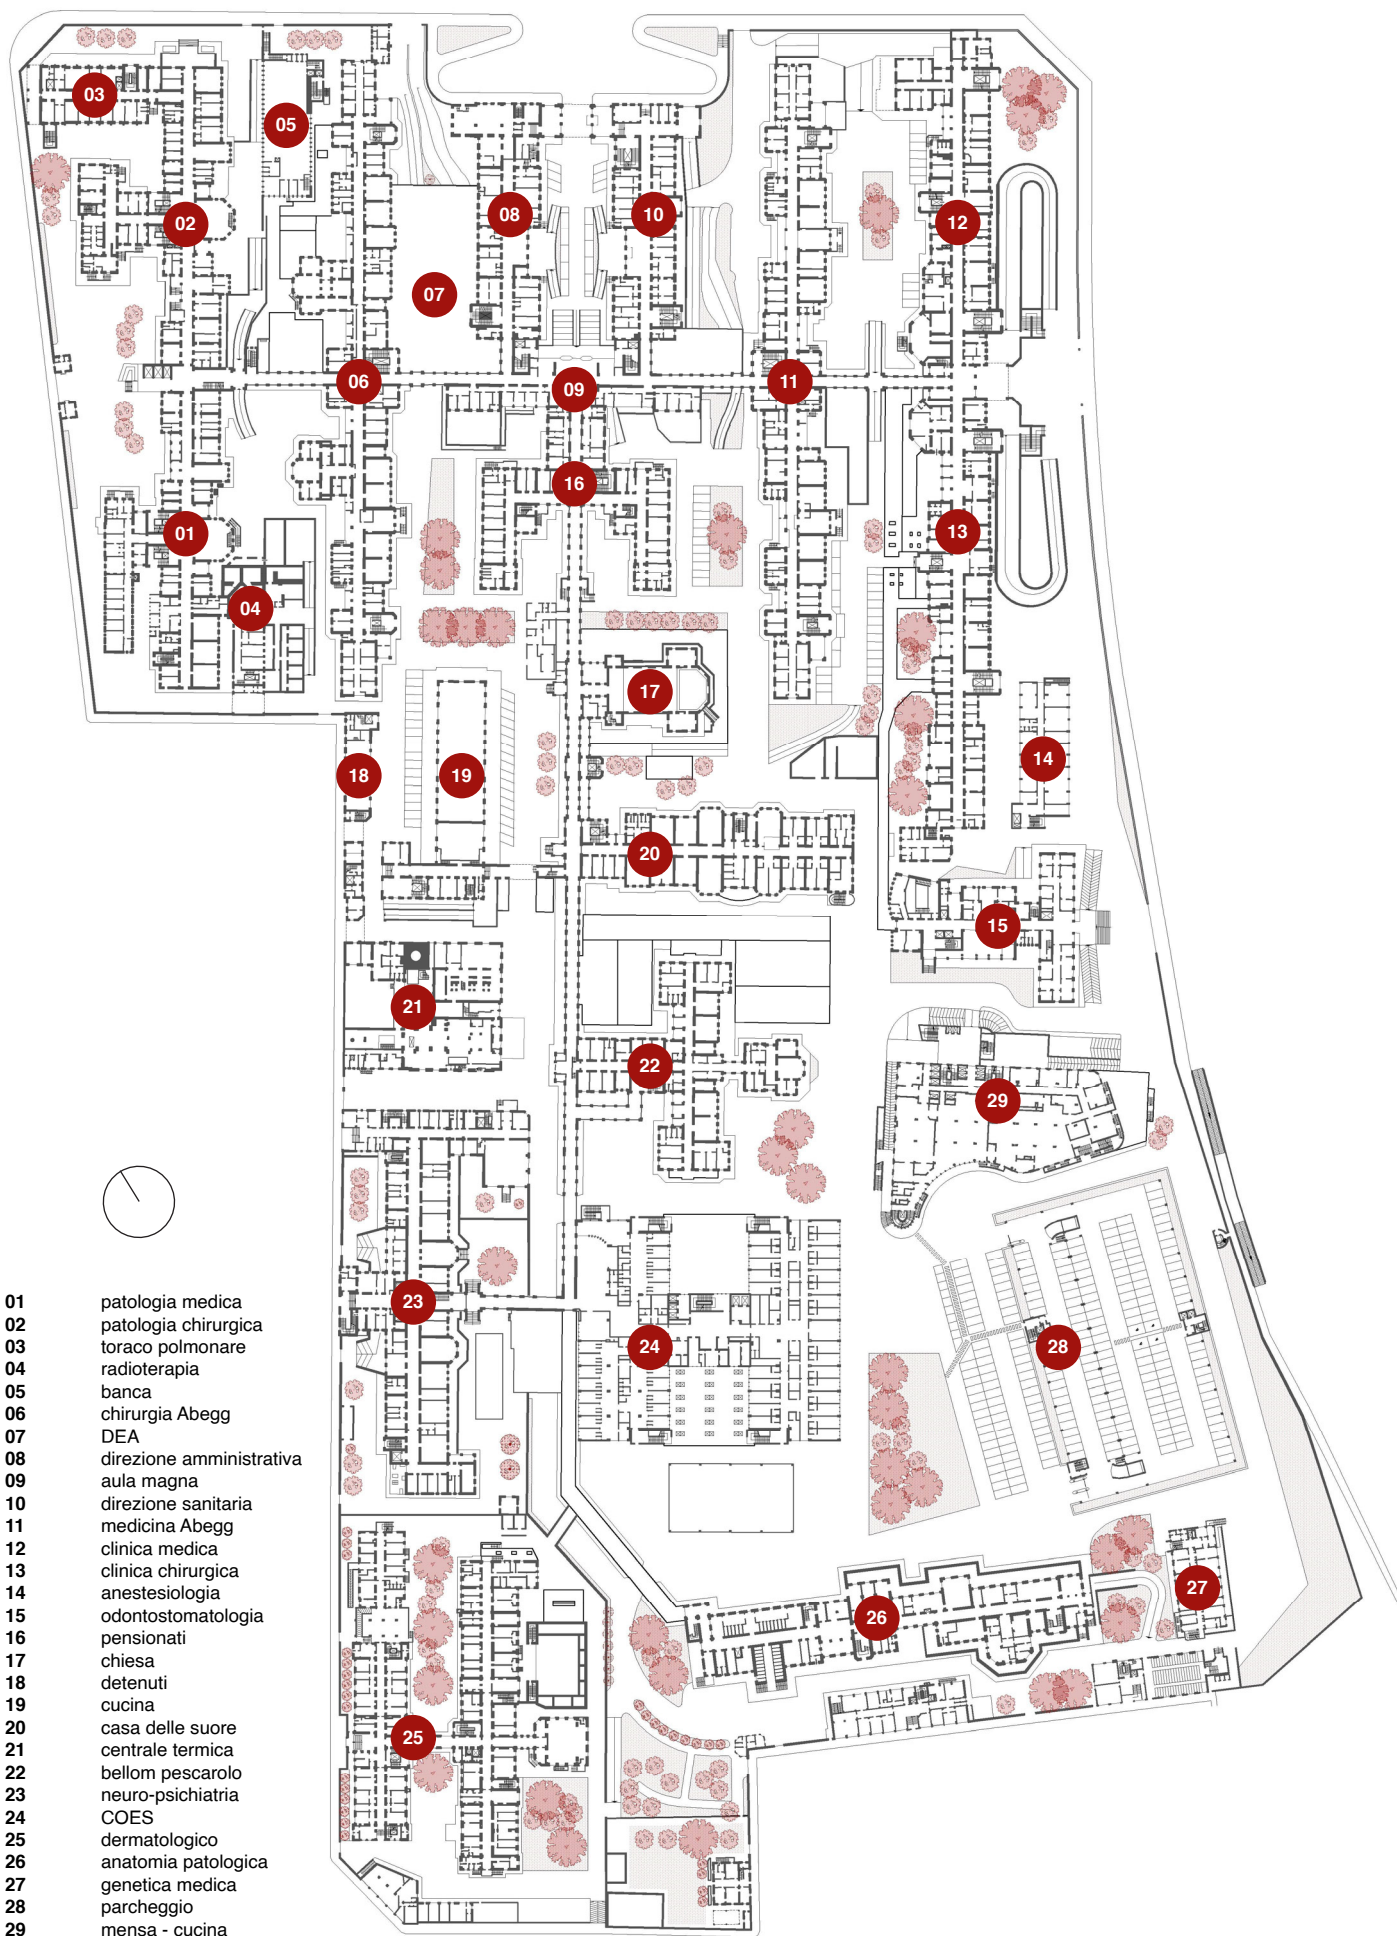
pianta piano rialzato dello stato di fatto, fuori scala
